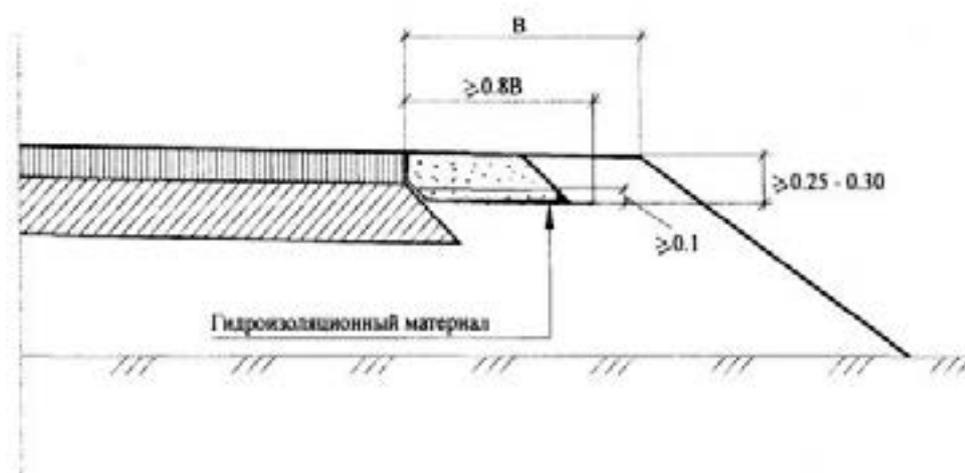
Конструкция гидроизоляции обочины на пучинистых грунтах
